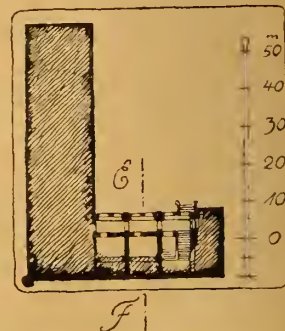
Erdgeschoßgrundriß des Jesuitenkollegs.
